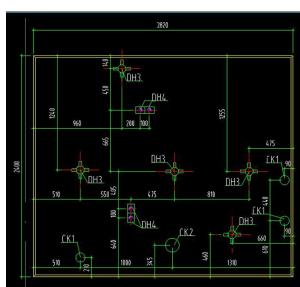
预制混凝土预留孔洞及对应明细(单位: mm)
